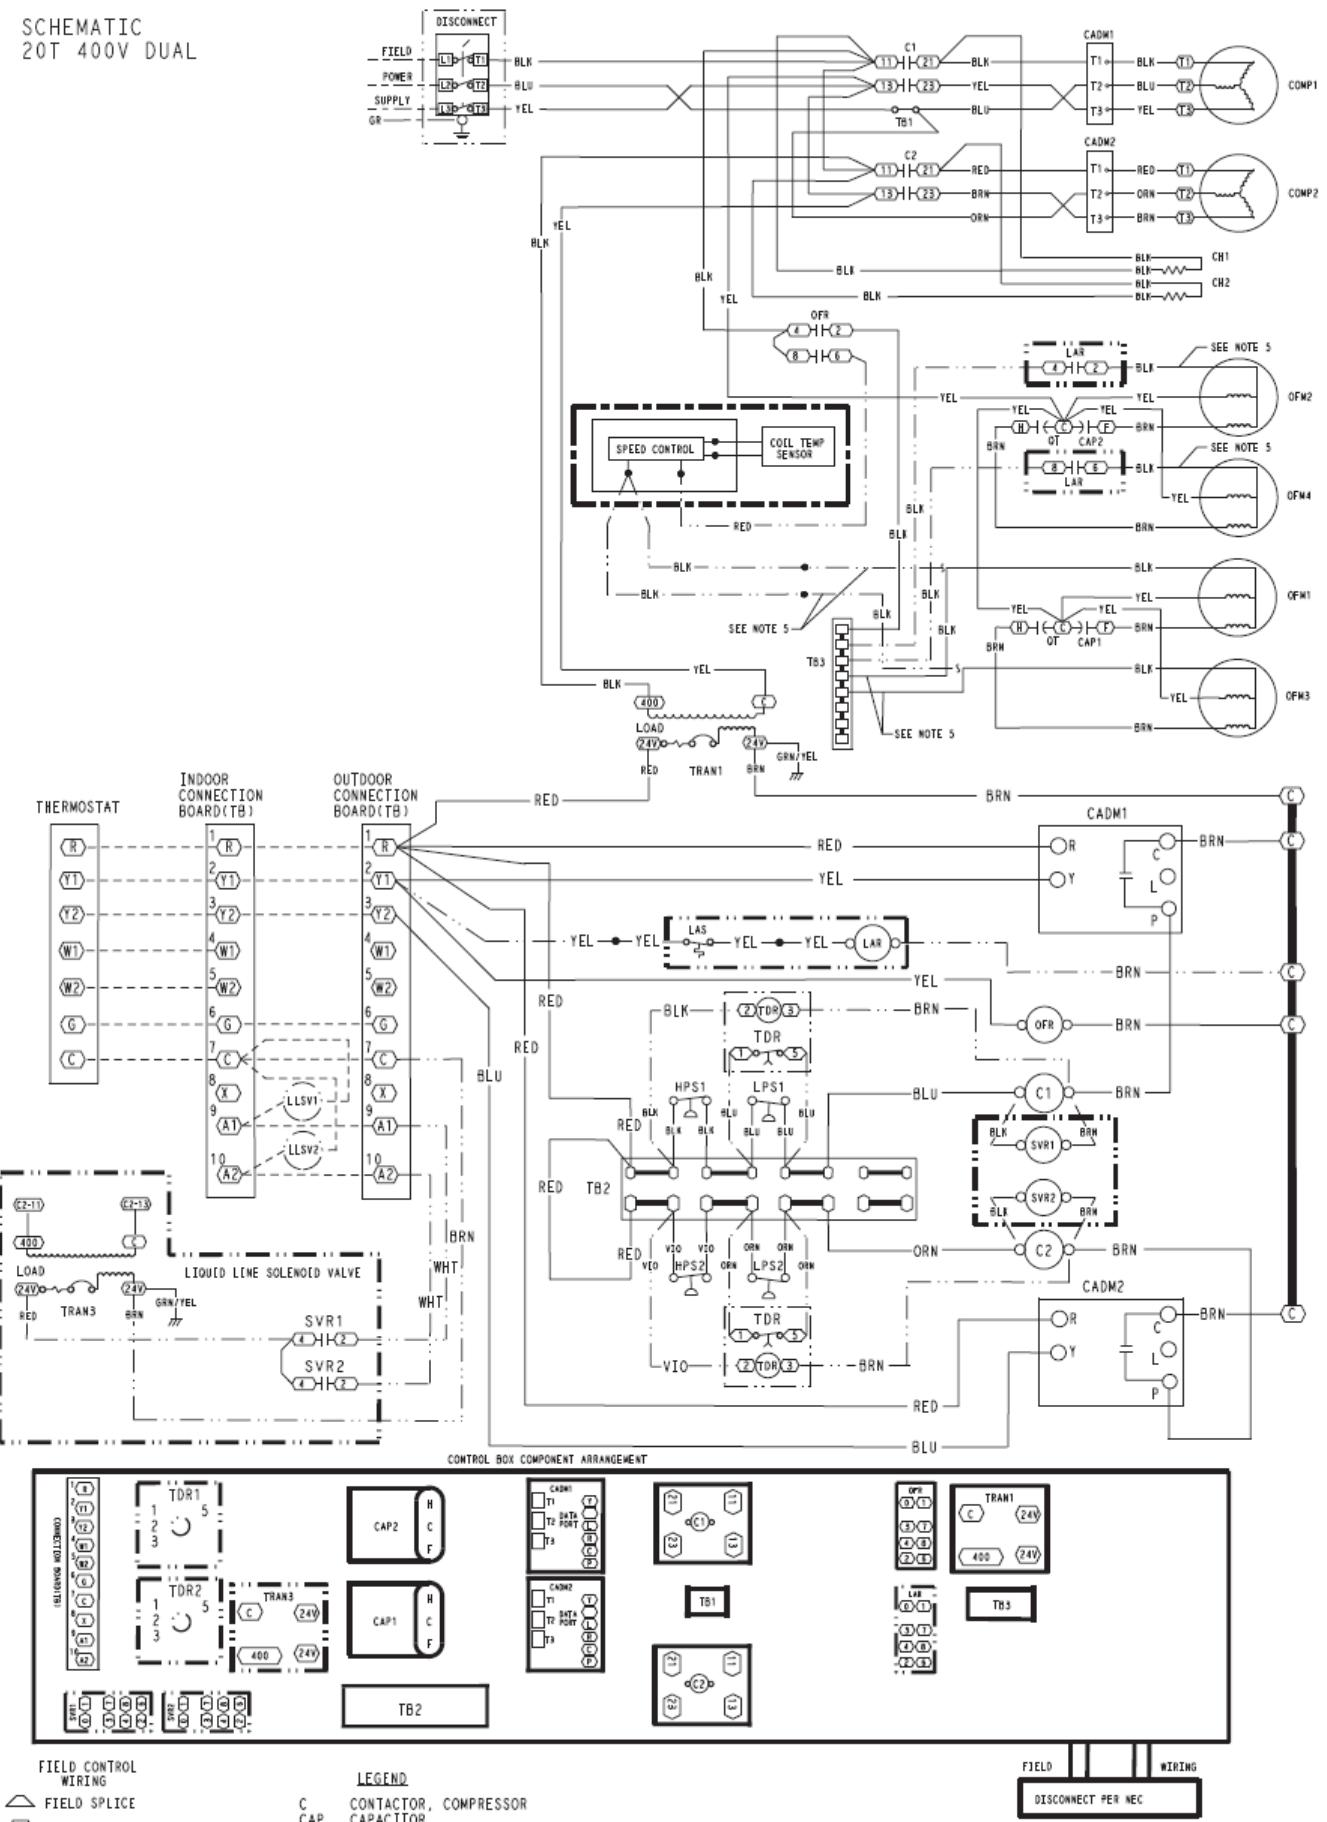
Типовая схема монтажа электропроводки блока 38AUD\*25
